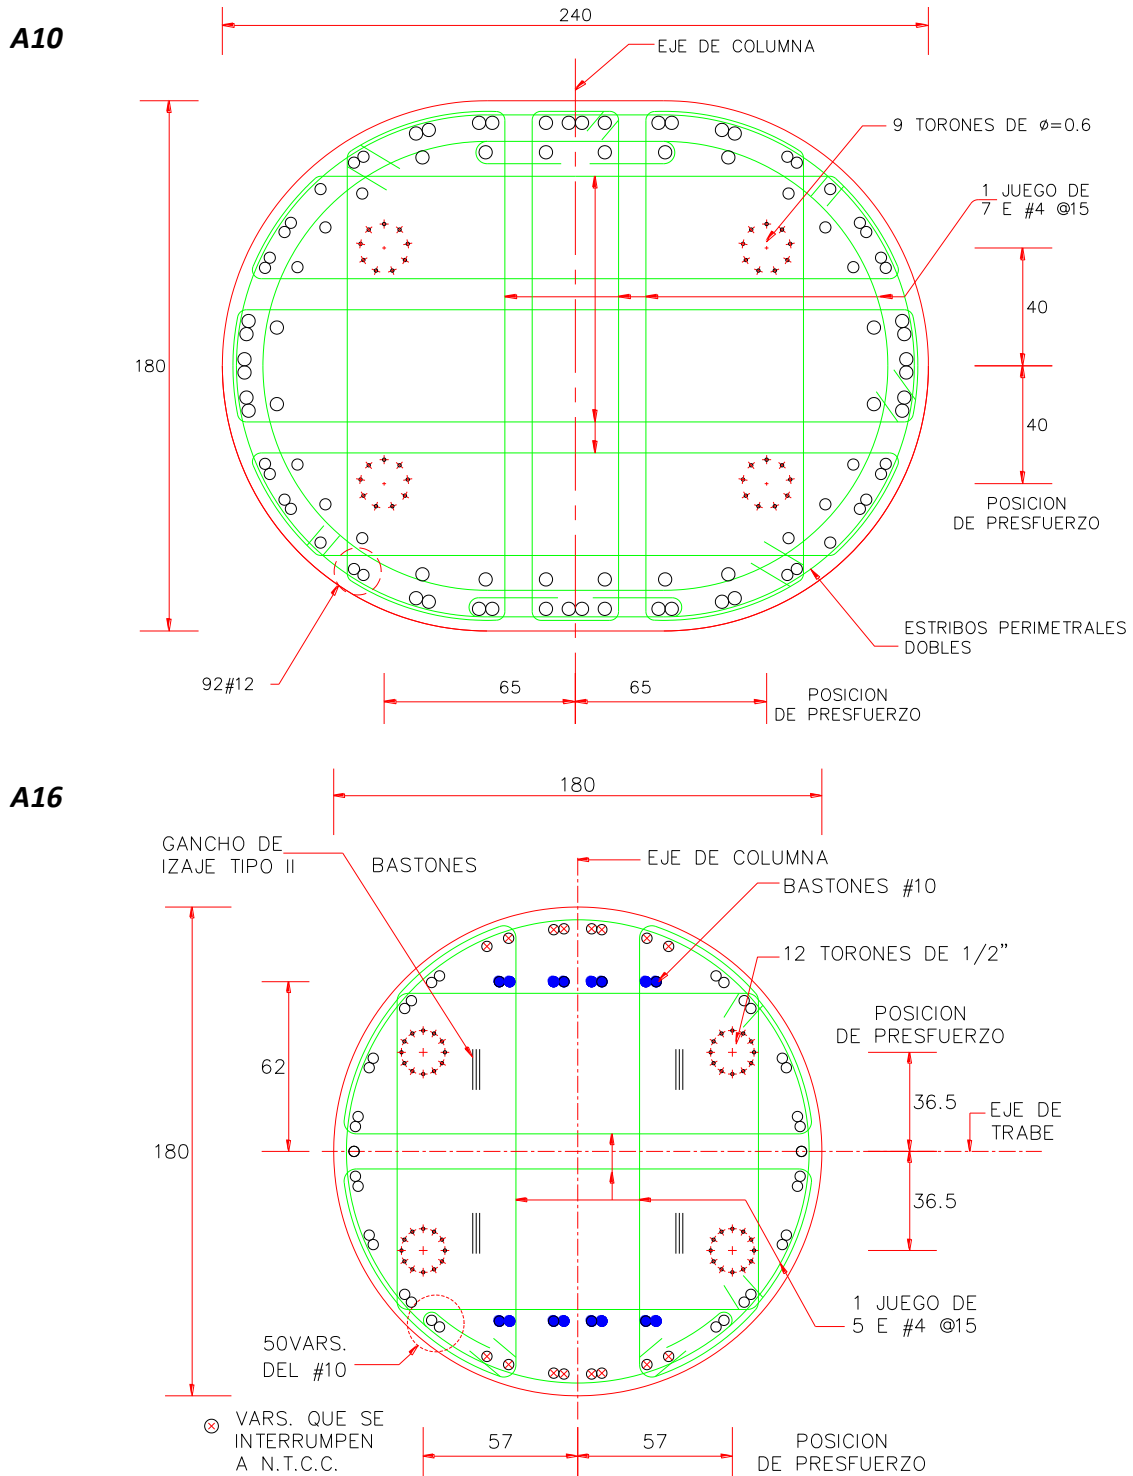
Secciones transversales de las columnas A10 y A16. Dimensiones en cm.
